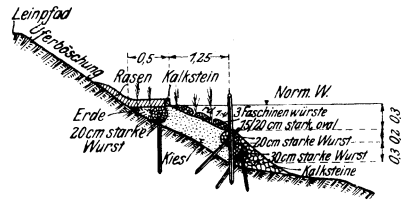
Befestigung eines abbrüchigen Ufers am Friedrich-Wilhelm-Kanal.
